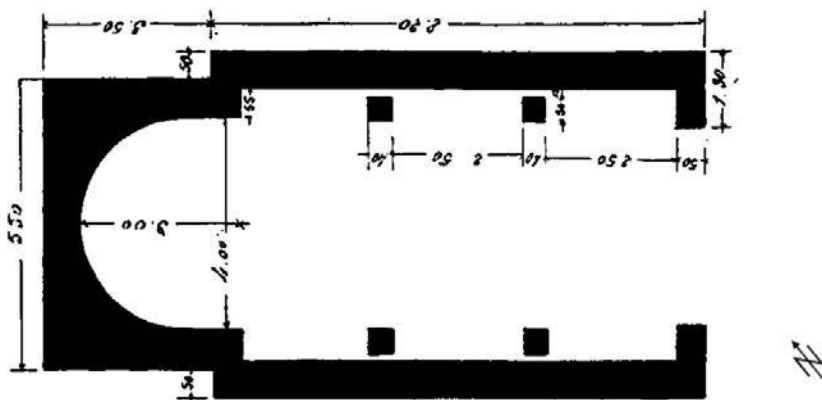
Kinfiria/Henchir Brahim Riah“. Plan der Kirche
